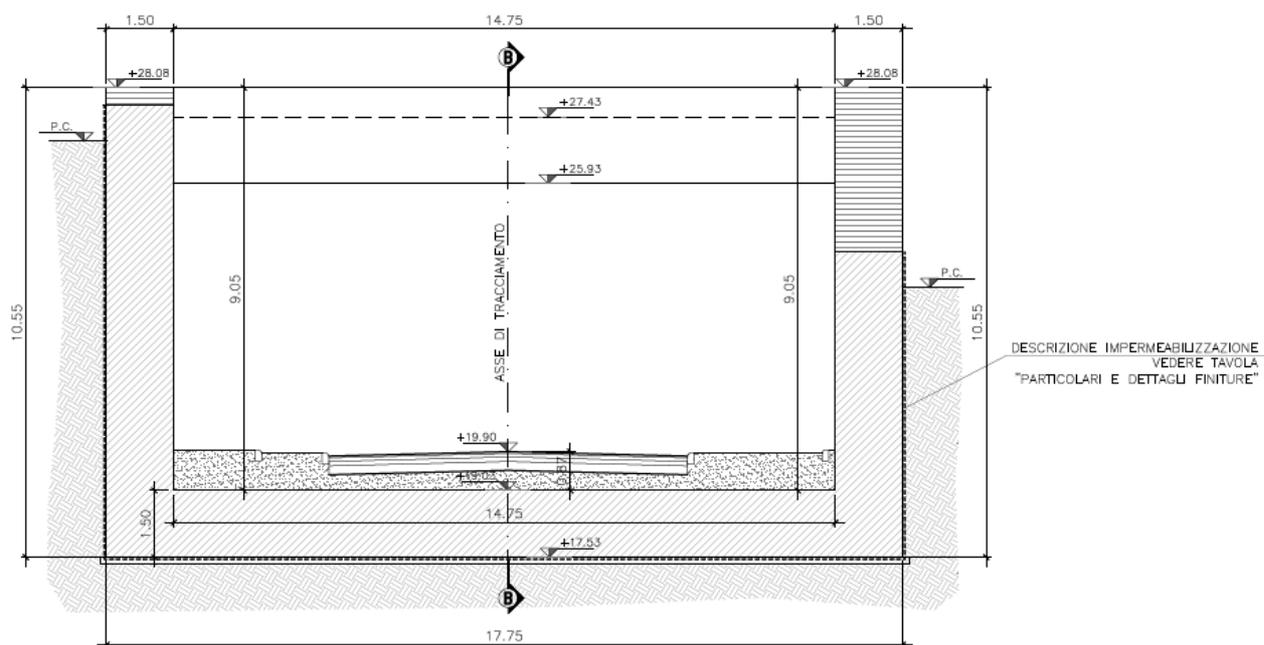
Muro di sbocco/imbocco - Sezione trasversale
